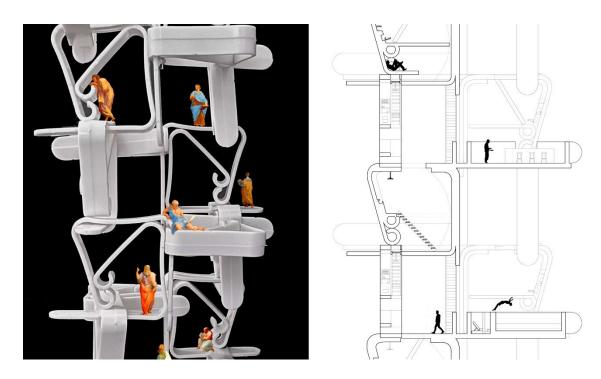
Propuesta viviendas en la favela Roziña, Río de Janeiro, Brasil Maqueta y desarrollo planimétrico. Autora: Fiona Vessuri. Fuente: Proyectos 1 y 2. Ud. Aranguren + Gallegos (2023)
